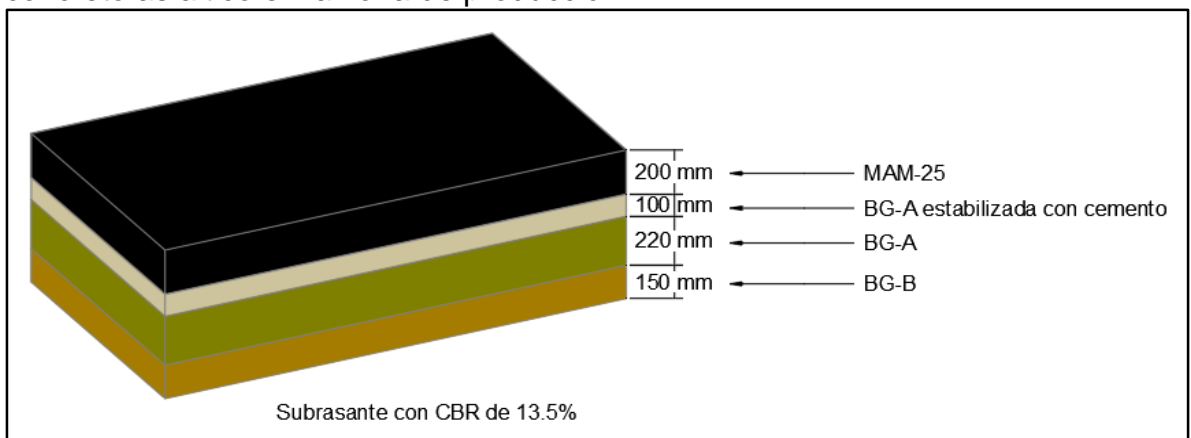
Sección propuesta para el pavimento industrial con capa de rodadura en concreto asfáltico en la zona de almacenaje del terminal.
